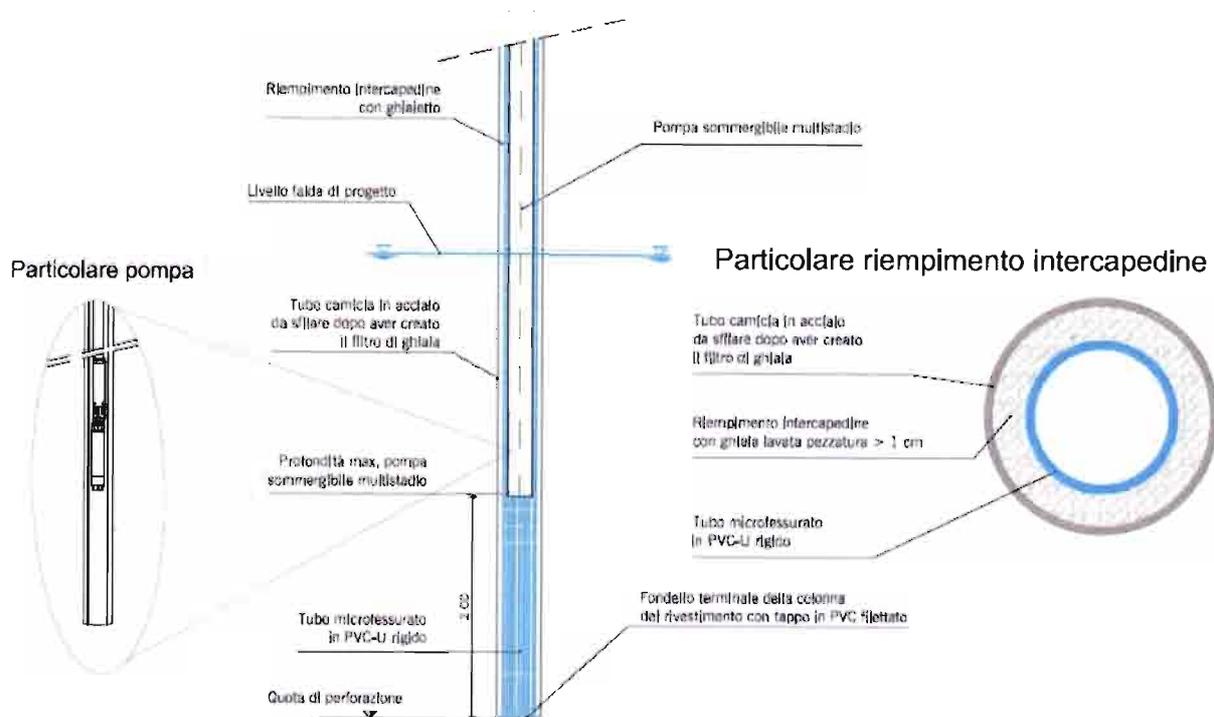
Sezione tipo del pozzo e particolare riempimento intercapedine.
